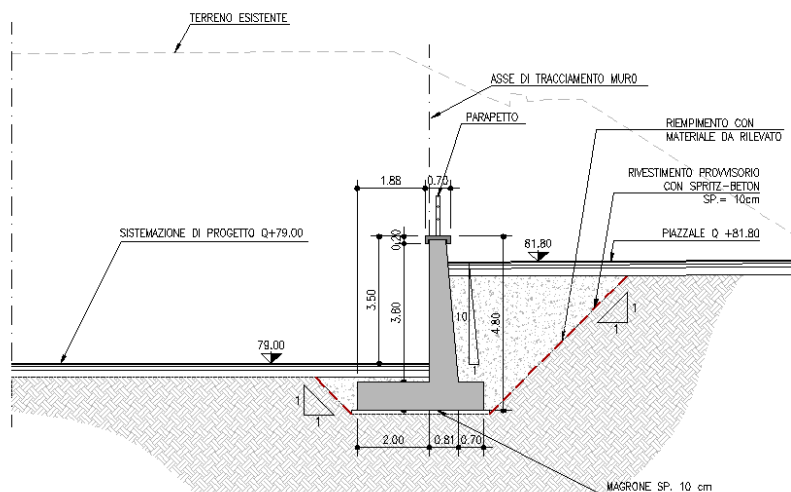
Muro di controripa MC02 – Sezione tipo
